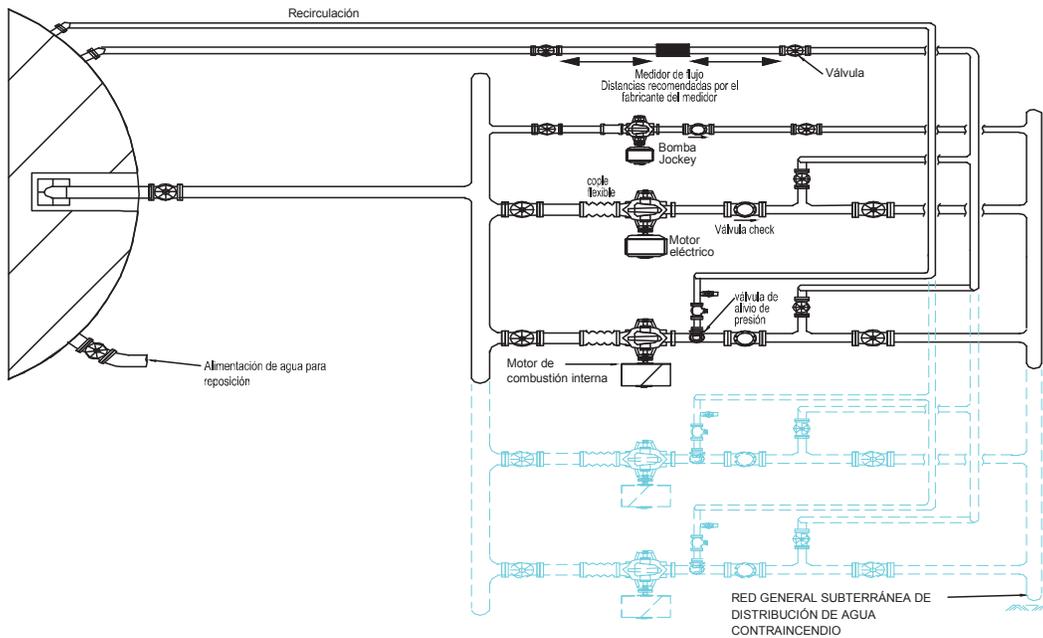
Arreglo típico del sistema de bombeo para la alternativa B.
